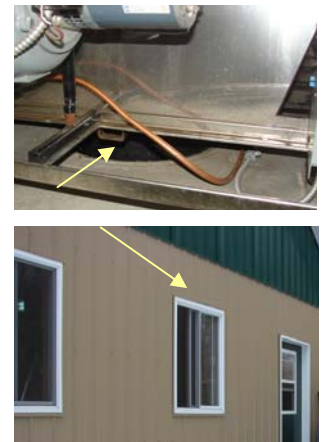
Entrée d'air dans le plancher (photo du haut) et par une fenêtre (du bas)
